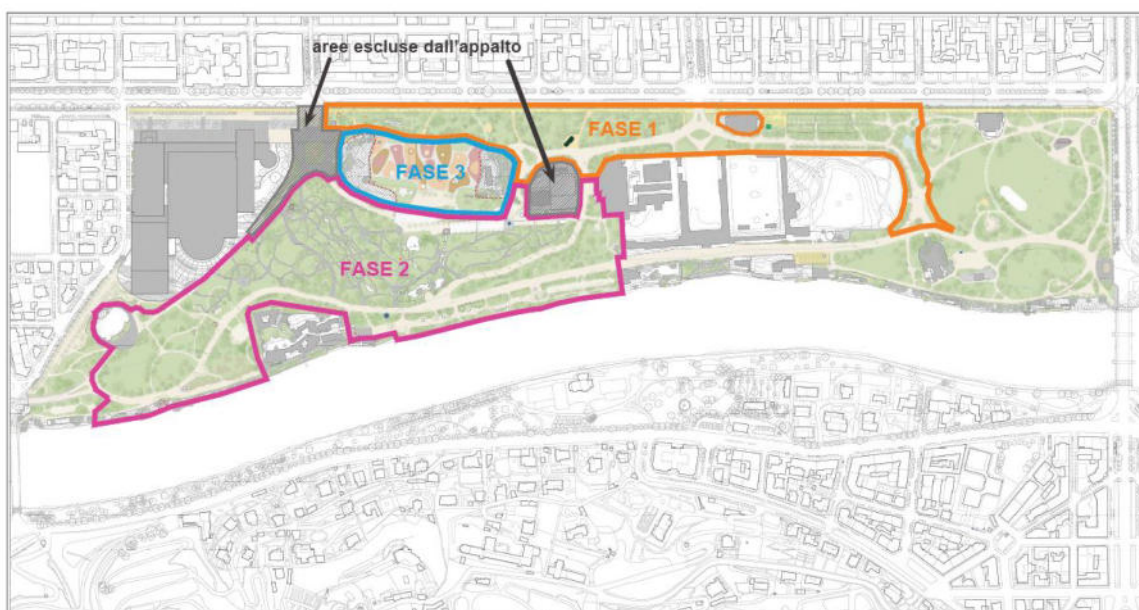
Fasi di cantiere e avanzamento temporale lavorazioni
